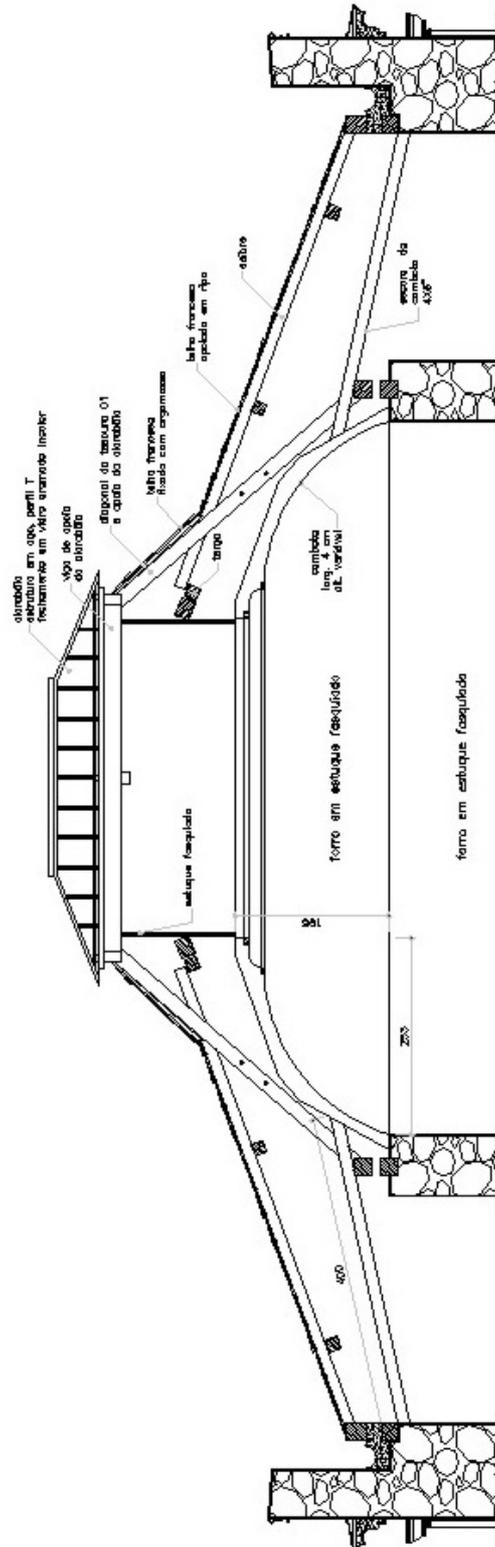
Detalhes construtivos de da estrutura da clarabóia.
